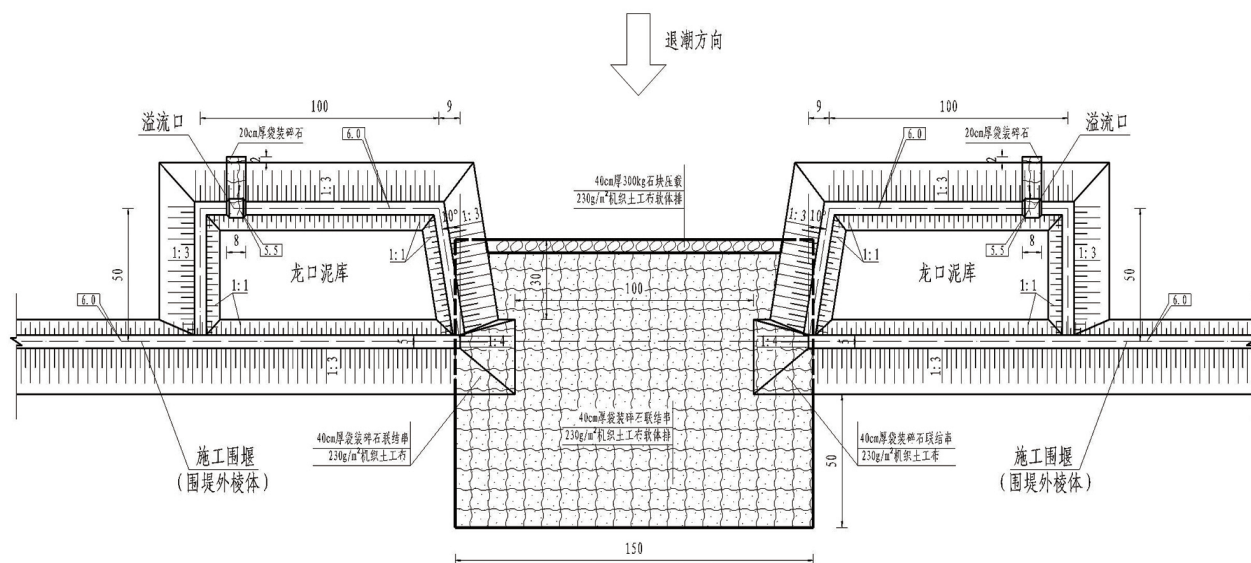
保护期龙口防护平面布置图 (单位: 高程 m, 尺寸 m)
